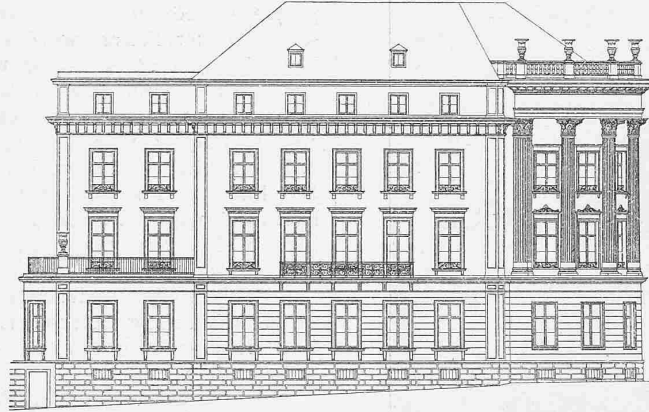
Gebäude der Handelsbank. Fassade gegen den Steinberg. Masstab 1:400.
